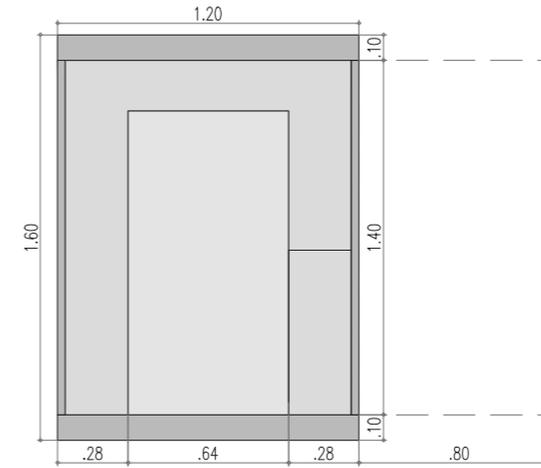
Planta puesto de venta estacionario tipo 3. Esc 1:30
